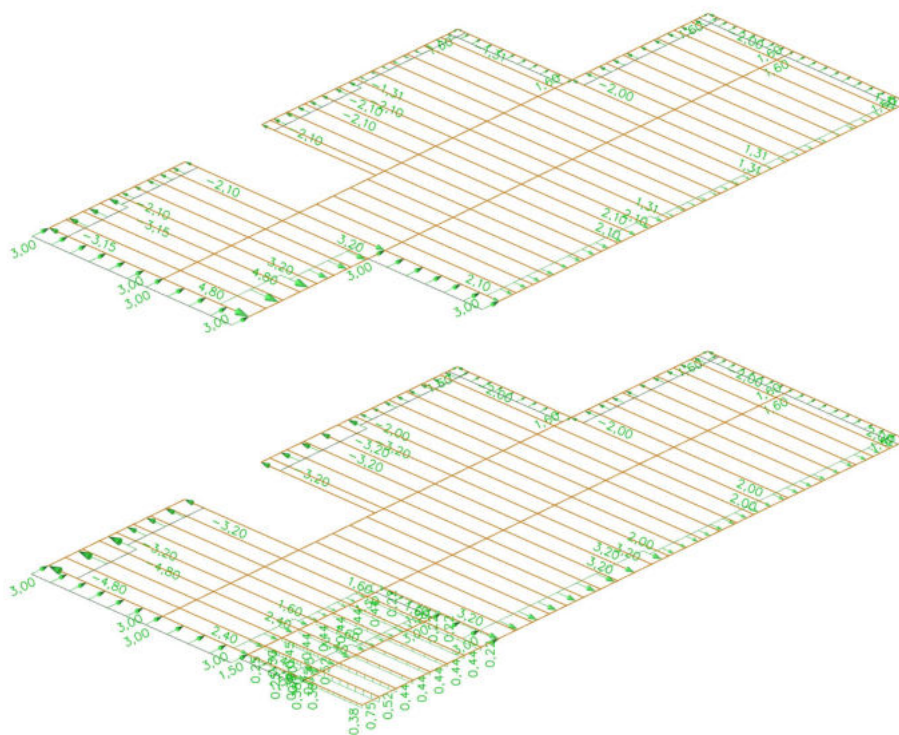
Zatížení stropní konstrukce příčným větrem zleva 1
